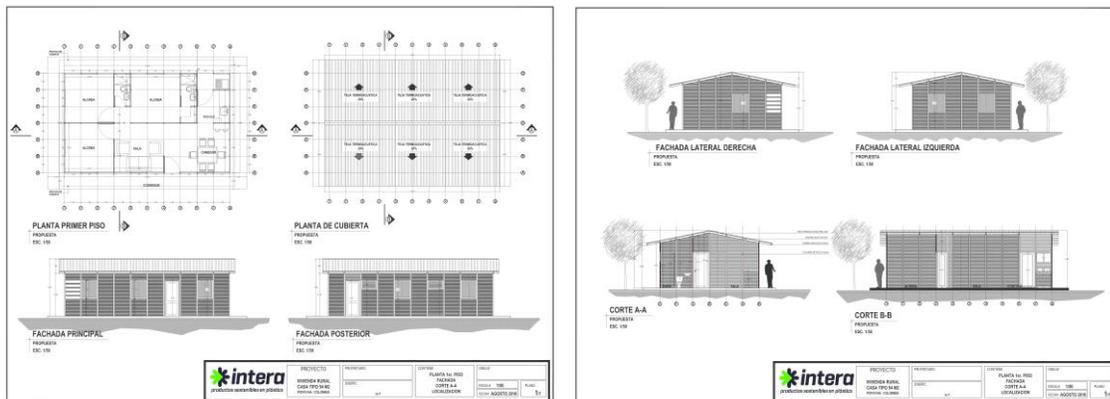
Planta Distribución Vivienda Rural 66 m<sup>2</sup> Sin Corredor. Fuente: Elaboración propia.
